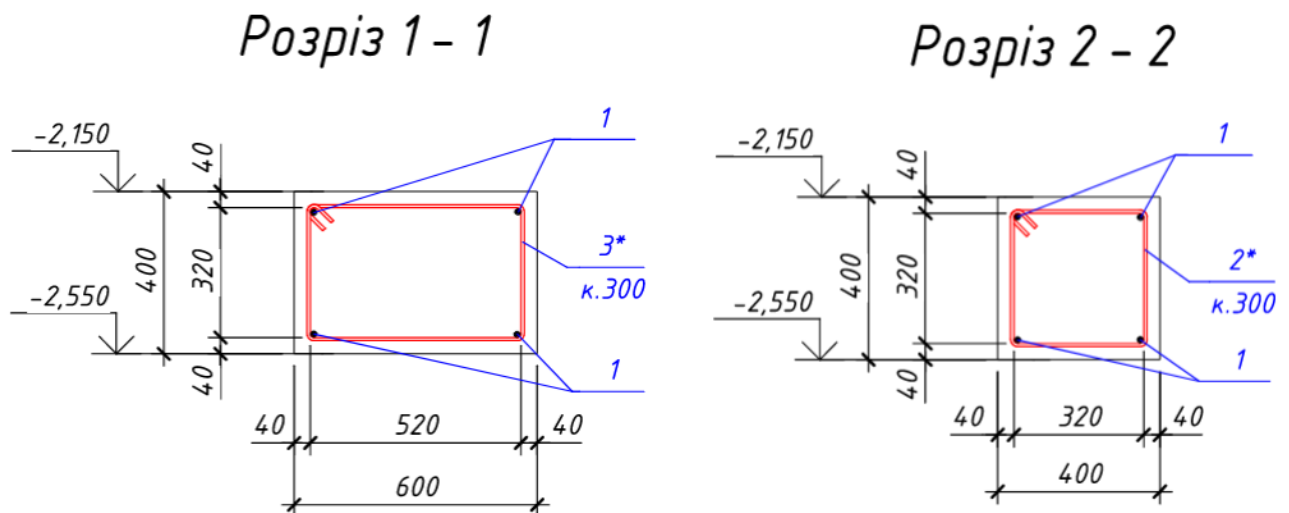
Схеми армування монолітного поясу Мп3
